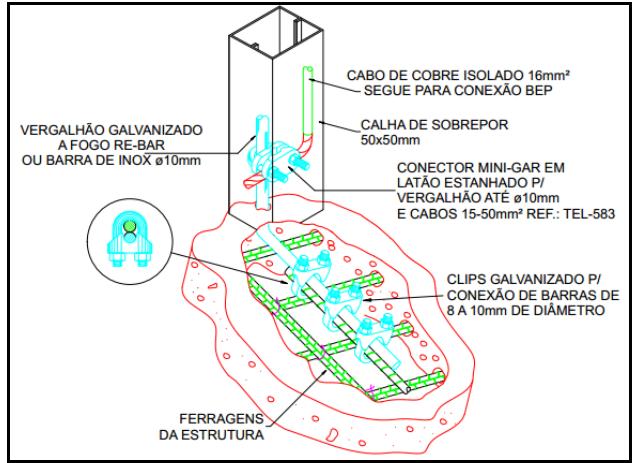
Amarração das ferragens do Radier com vergalhão galvanizado
